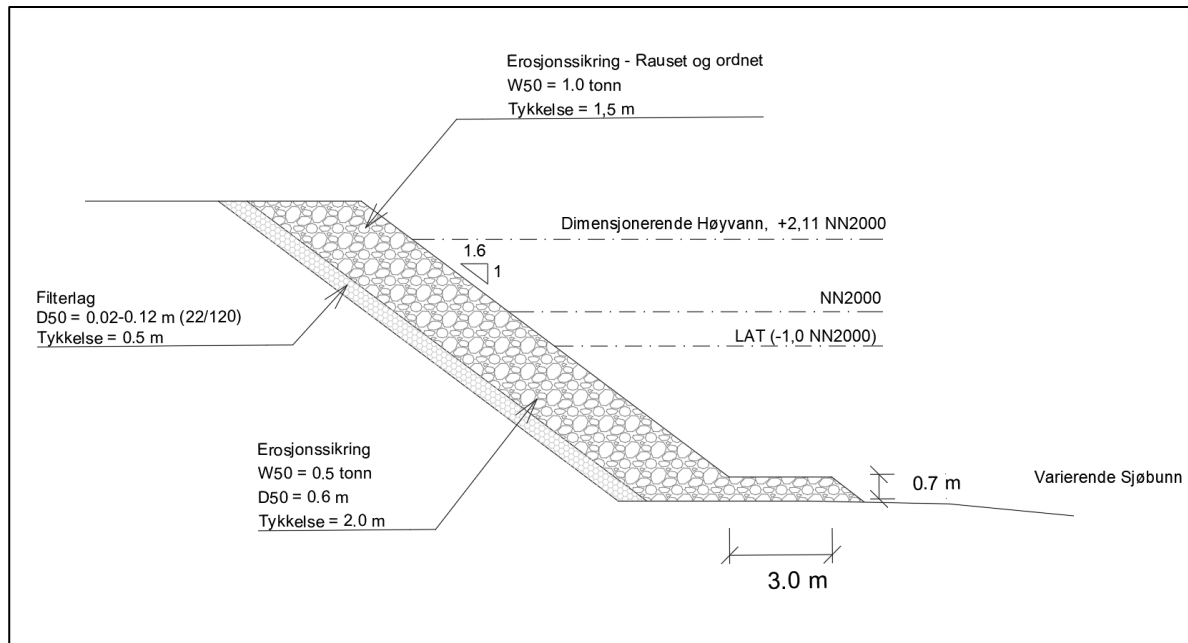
Dagens erosjonssikring foran planlagte boligområdet på Storøy/Pallefabrikken (til høyre i bildet over).
